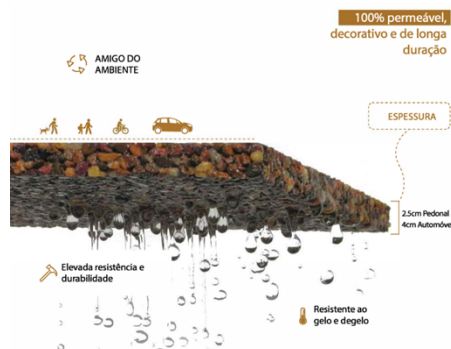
Imagem pavimento permeável (Fonte 32)
